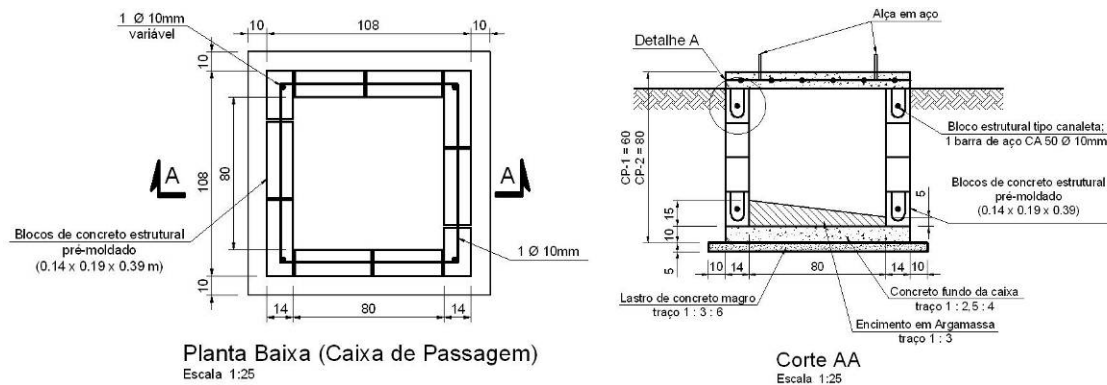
Detalhes construtivos das caixas de passagem
